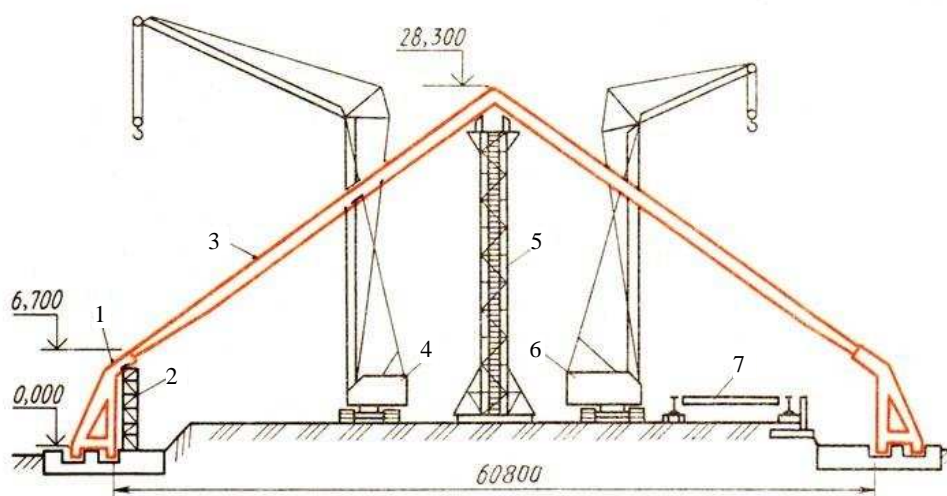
Схема блокового монтажу арочного покриття: 1 – залізобетонний контрфорс; 2 – риштування переставні; 3 – ригель арки; 4 – гусеничний кран для монтажу блоків; 5 – тимчасова опора з маршевіми сходами; 6 – гусеничний кран для монтажу міжблокових конструкцій, 7 – блок, що укрупнюється
